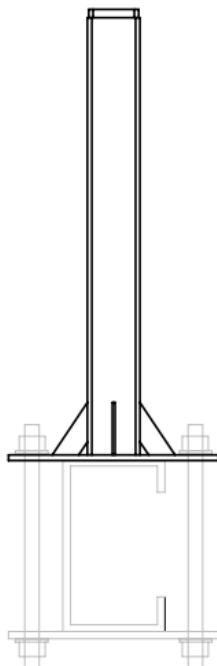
fixação do pilarete metálico na estrutura do telhado para a linha de vida.
